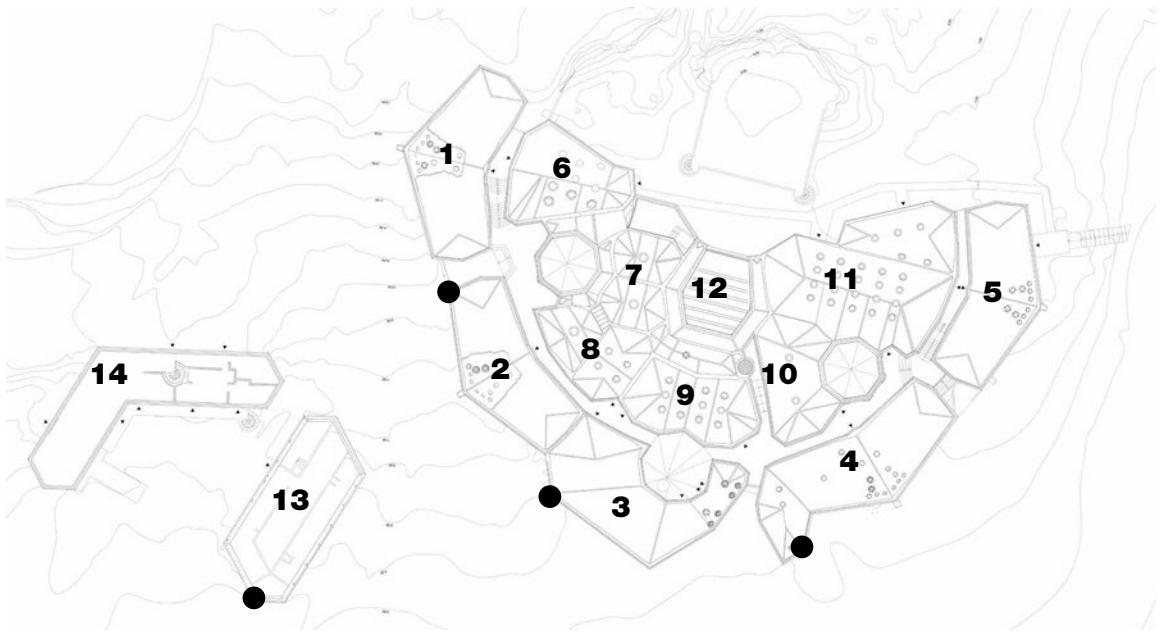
| Esquema planimétrico con los puntos donde se realizaron las pruebas de cimentación. | Schema planimetrico con i punti in cui sono stati realizzati i saggi di fondazione.
